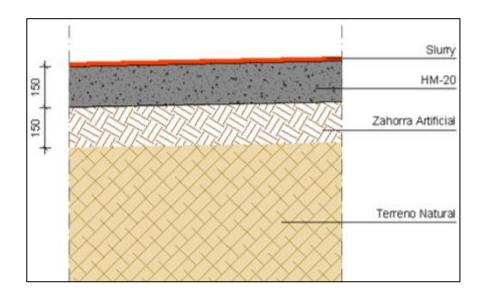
Detalle sección tipo del carril bici. Fuente: Propia
